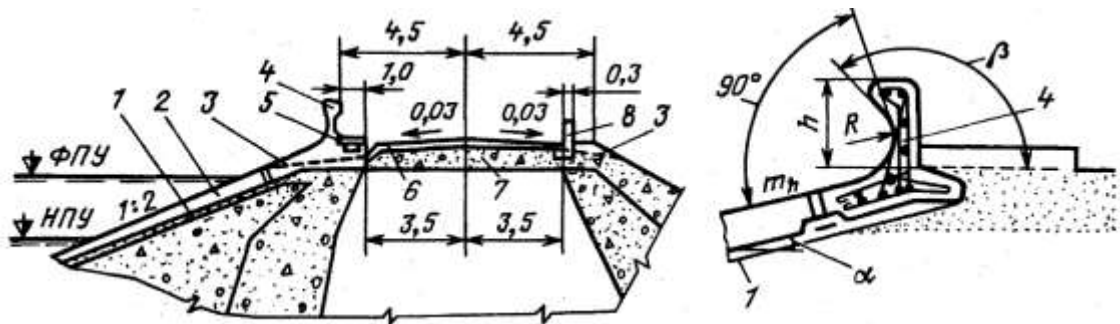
Пример конструкции гребня плотины с волноотбойным парапетом: 1 – подготовка; 2 – железобетонное крепление; 3 – ливнесток; 4 – волноотбойный парапет; 5 – тротуар с каналом для кабеля; 6 – асфальтобетонное покрытие; 7 – подготовка из песчано-гравийного грунта; 8 – надолбы; $R \approx 0,5h$; $\beta = (130^\circ \dots 140^\circ) - \alpha$
